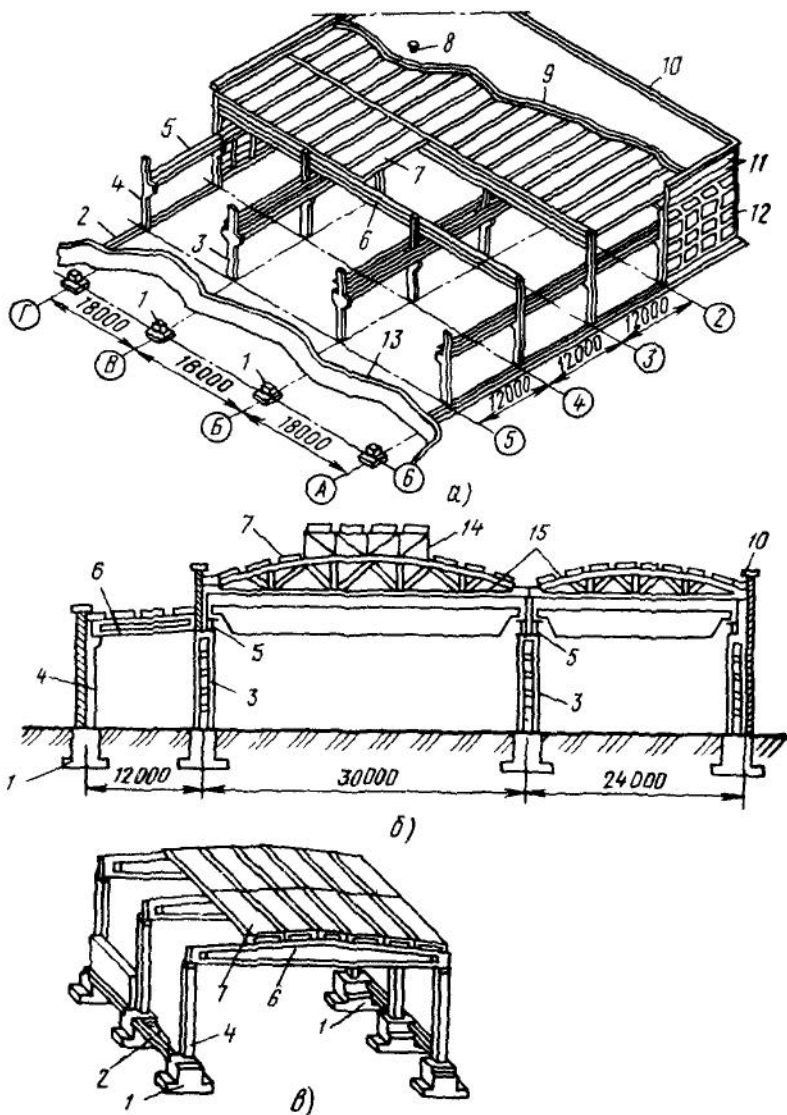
Схемы каркасов одноэтажных промышленных зданий: а — многопролетного с плоской кровлей, б — многопролетного с мостовыми кранами, в — однопролетного; 1 — фундаменты, 2 — фундаментные блоки (ранбалки), 3, 4 — колонны среднего и крайнего рядов, 5 — подкрановые балки, 6 — балки покрытия, 7 — плиты покрытия, 8 — воронки внутреннего водостока, 9 — утеплитель покрытия и рулонная кровля, 10 — парапет, 11 — панель стены, 12 — оконный витраж, 13 — пол по грунту, 14 — фонарь, 15 — стропильные фермы
